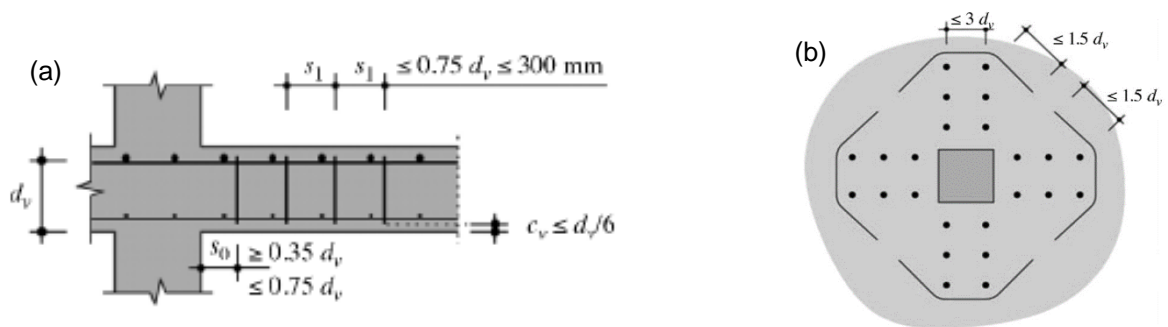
Disposição construtiva, presente no MC2010, para as armaduras transversais: (a) Em alçado; (b) Em planta [3]
